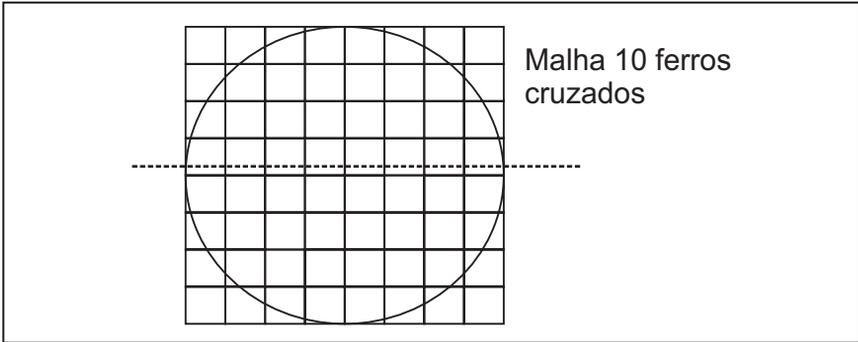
Estrutura da Malha de Ferro ¼' do Fundo da Cisterna
